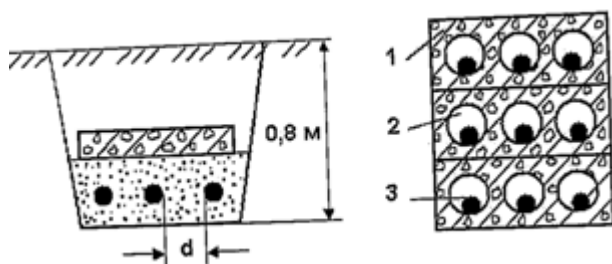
Эскиз прокладки кабелей в земляной траншее (а) и бетонном блоке (б).
